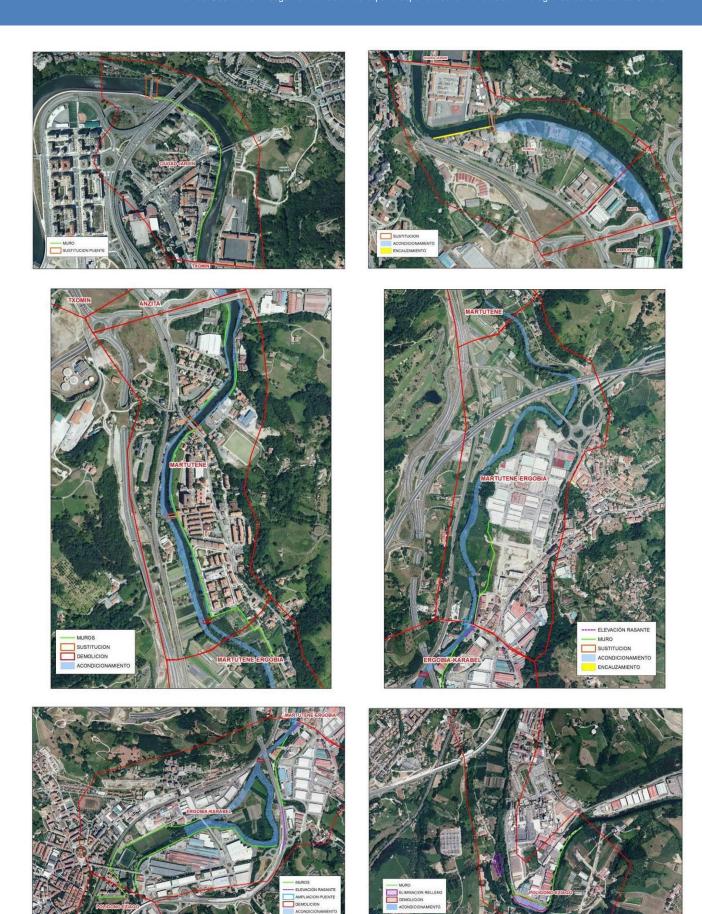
Planta de actuaciones planteadas por ámbito. ARPSI de Urumea
